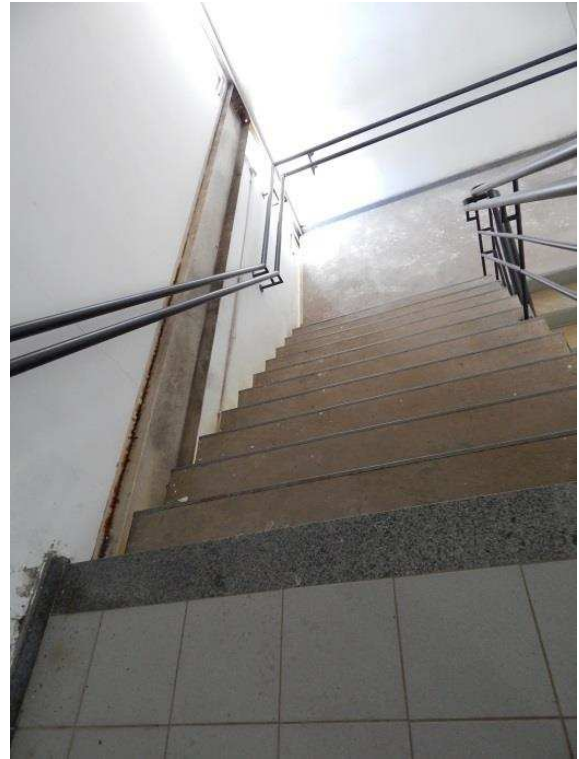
Vista da viga metálica e escada interna, antes da realização do ensaio.
